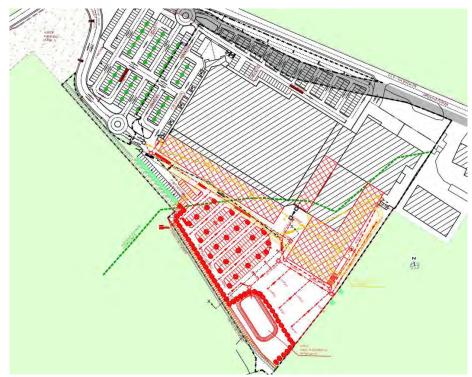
Planimetria stato di fatto con sovrapposizione stato di progetto (in rosso gli edifici e pertinenze in progetto).
